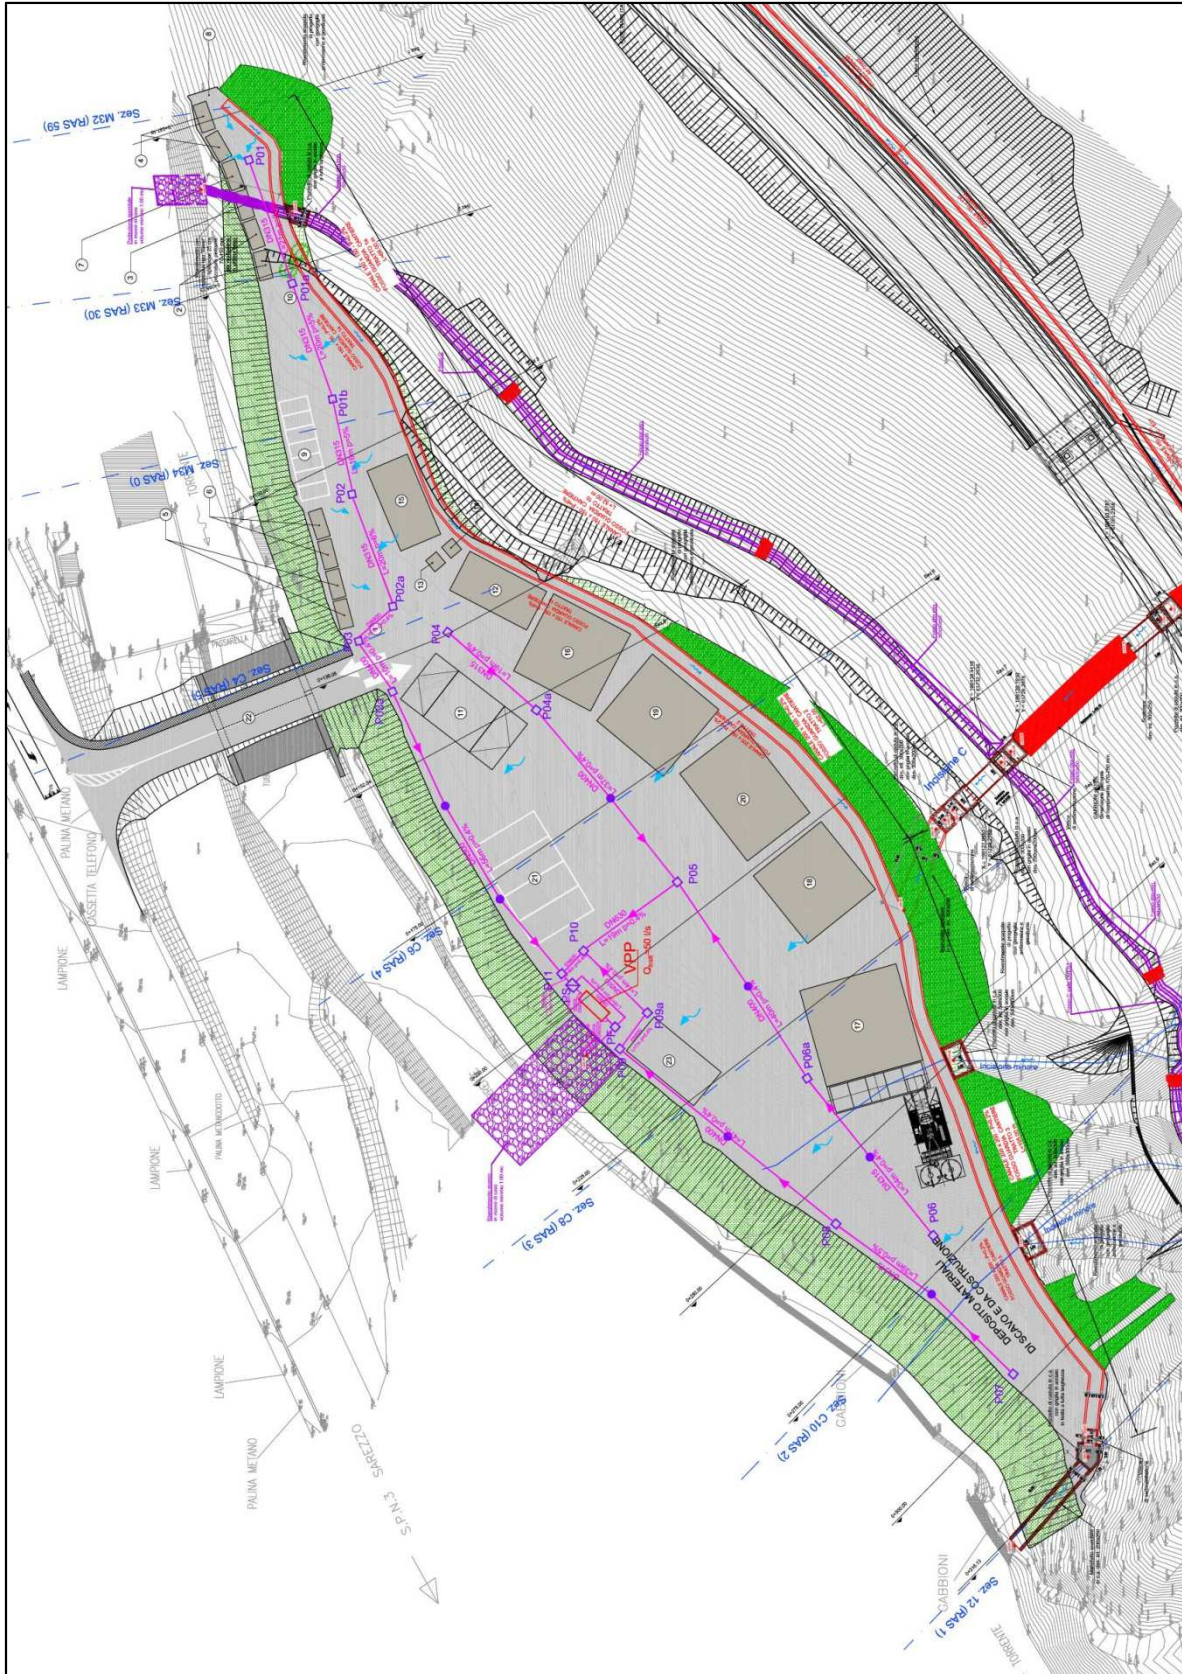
Canale di guardia ed opere accessorie Cantiere – Planimetria di progetto
